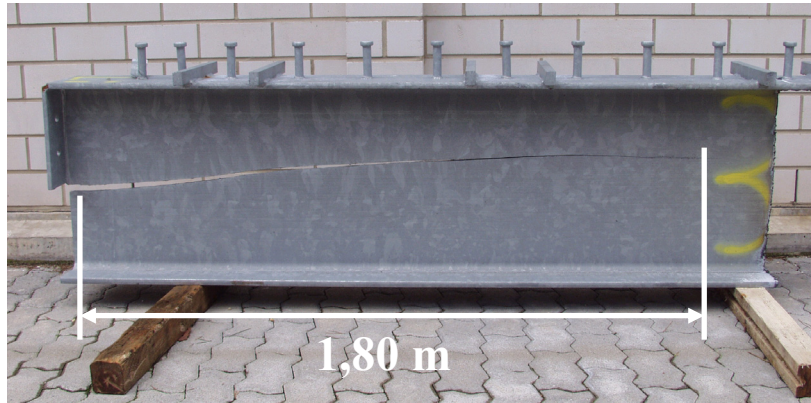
Ejemplo de grieta surgida durante la galvanización en caliente de un perfil de un aparcamiento de Colonia, Alemania, y no detectada hasta la primera inspección (imagen facilitada por la Universidad de Kaiserslautern, Alemania) [7].
